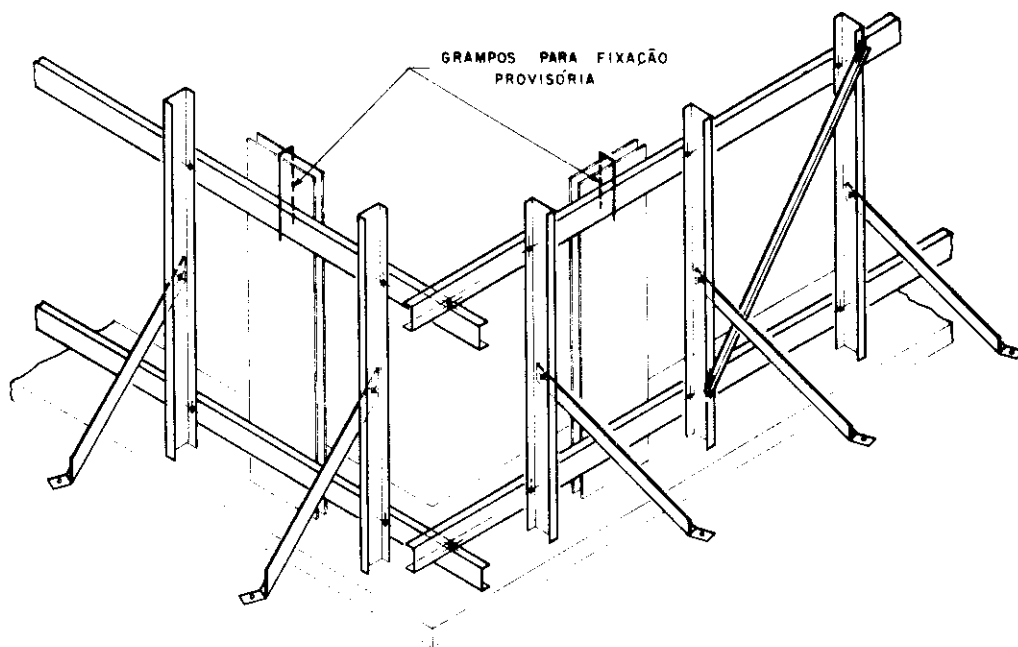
SISTEMA DE MONTAGEM DO ESCORAMENTO METÁLICO E POSICIONAMENTO DOS PAINÉIS
